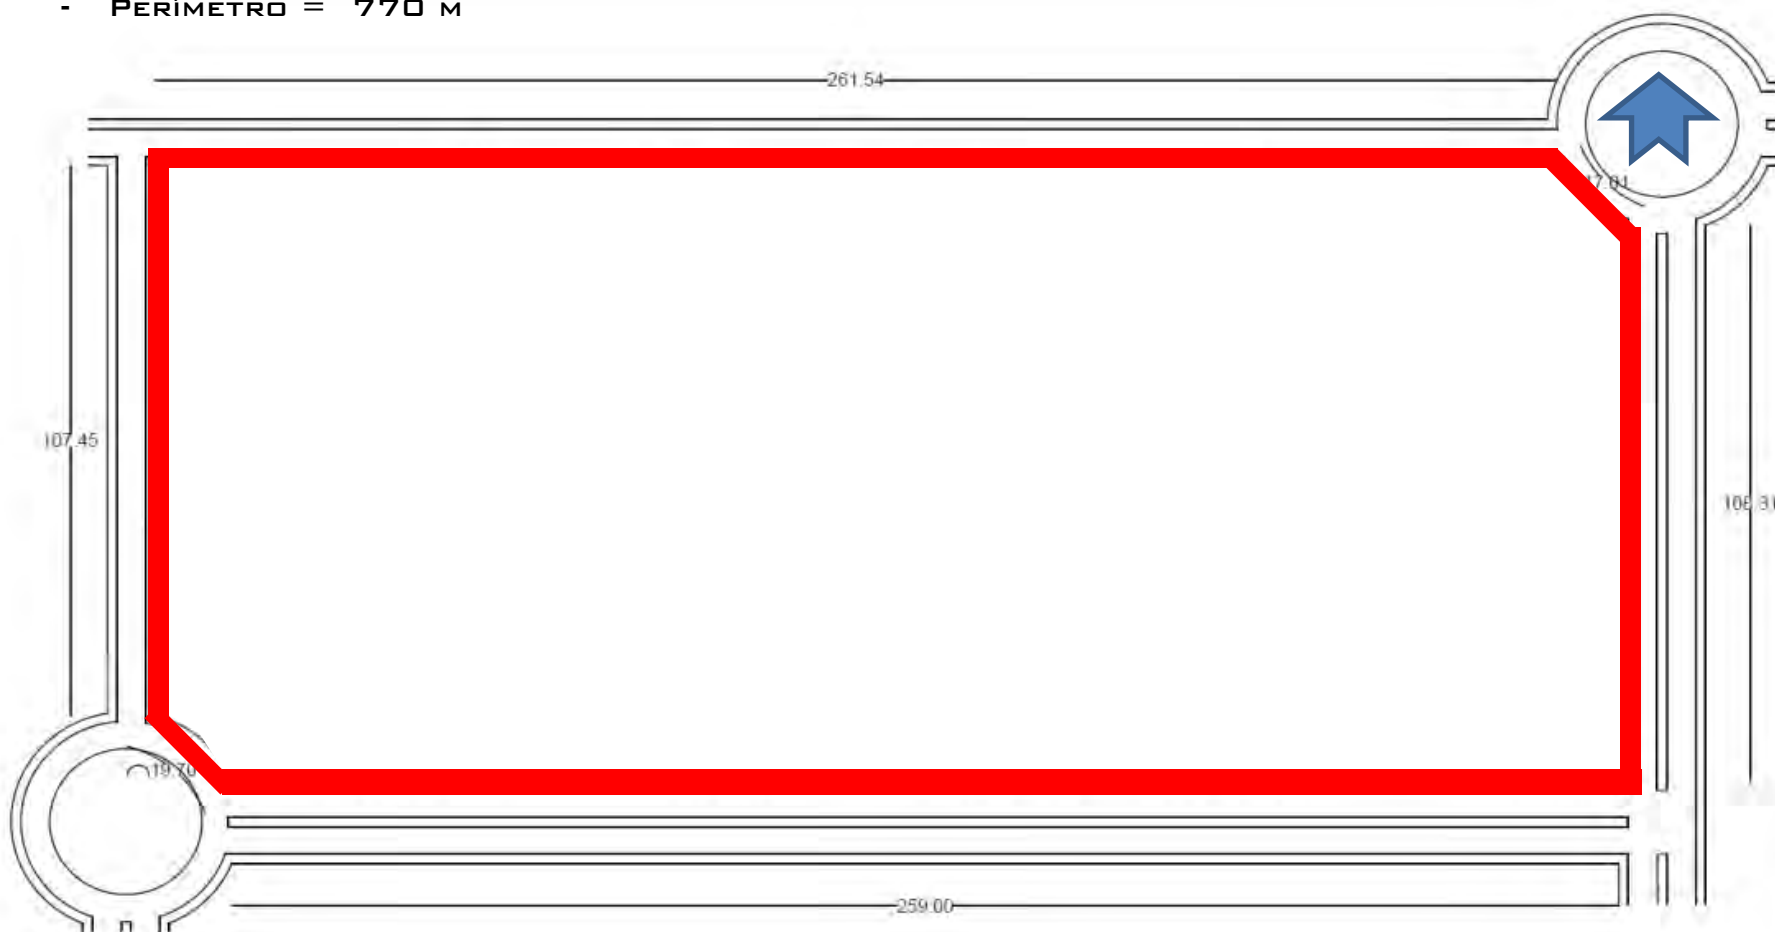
Plano del Terreno – Dibujo de Autoría Propia
